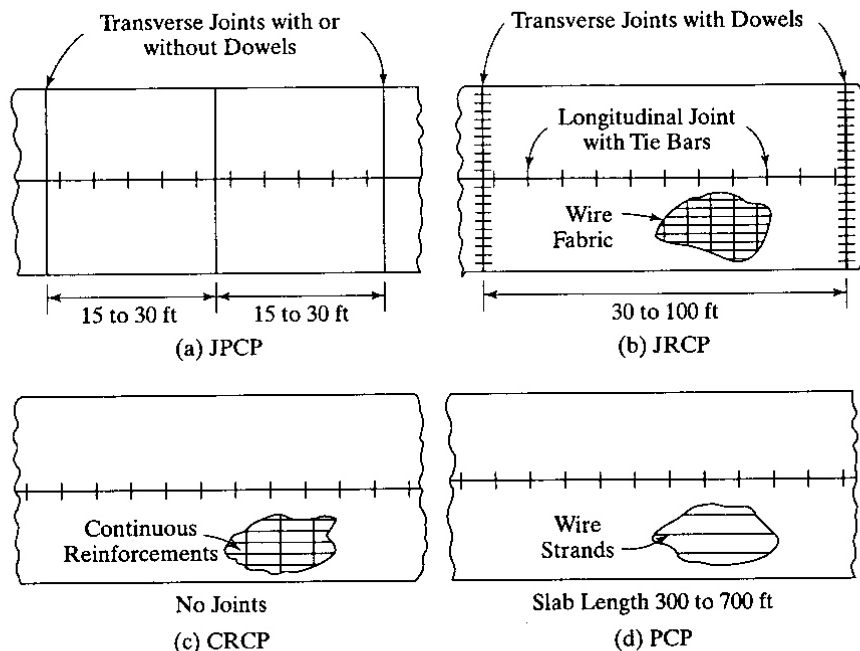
Tipologie di pavimentazioni in calcestruzzo
